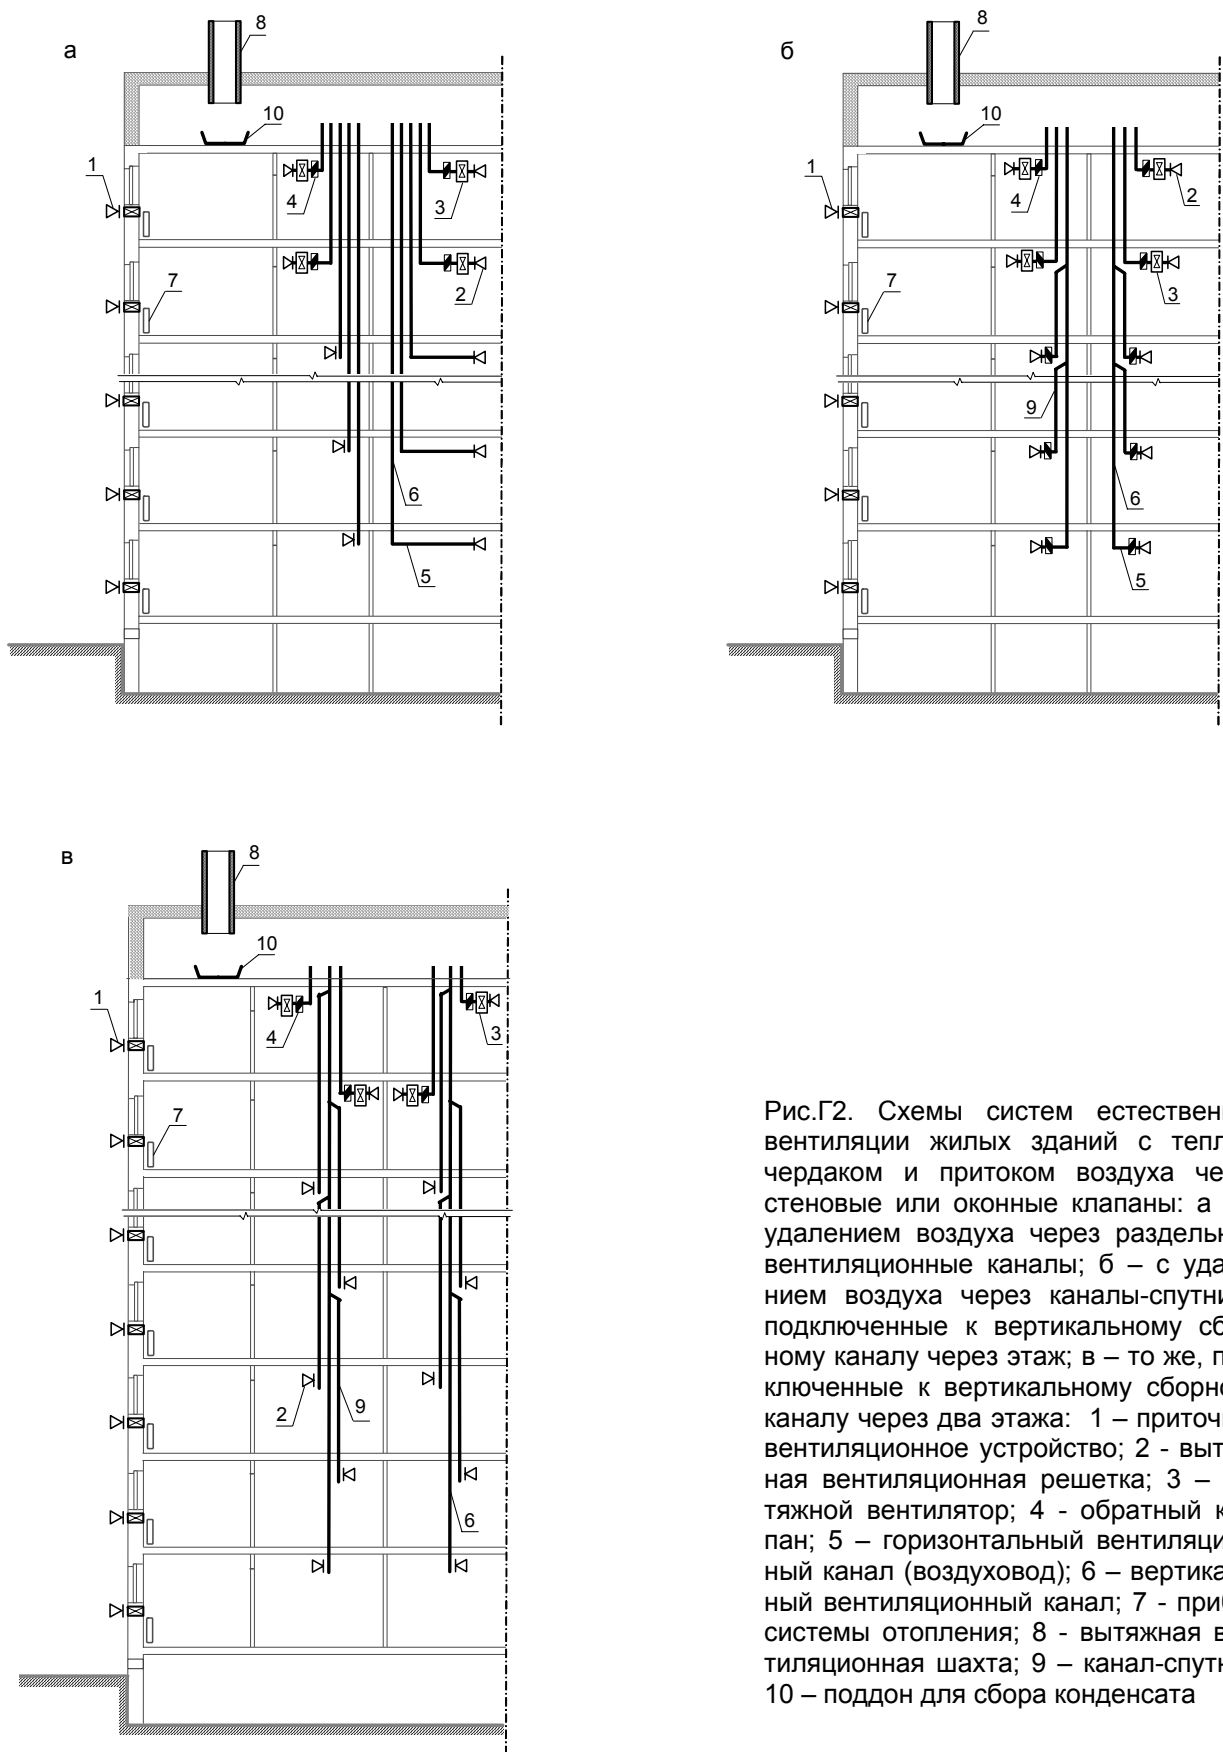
Схемы систем естественной вентиляции жилых зданий с теплым чердаком и притоком воздуха через стеновые или оконные клапаны: а – с удалением воздуха через отдельные вентиляционные каналы; б – с удалением воздуха через каналы-спутники, подключенные к вертикальному сборному каналу через этаж; в – то же, подключенные к вертикальному сборному каналу через два этажа: 1 – приточное вентиляционное устройство; 2 - вытяжная вентиляционная решетка; 3 – вытяжной вентилятор; 4 - обратный клапан; 5 – горизонтальный вентиляционный канал (воздуховод); 6 – вертикальный вентиляционный канал; 7 - прибор системы отопления; 8 - вытяжная вентиляционная шахта; 9 – канал-спутник; 10 – поддон для сбора конденсата
